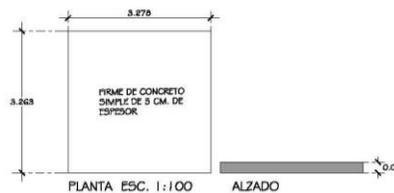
Planos arquitectónicos del módulo 3 y 4
